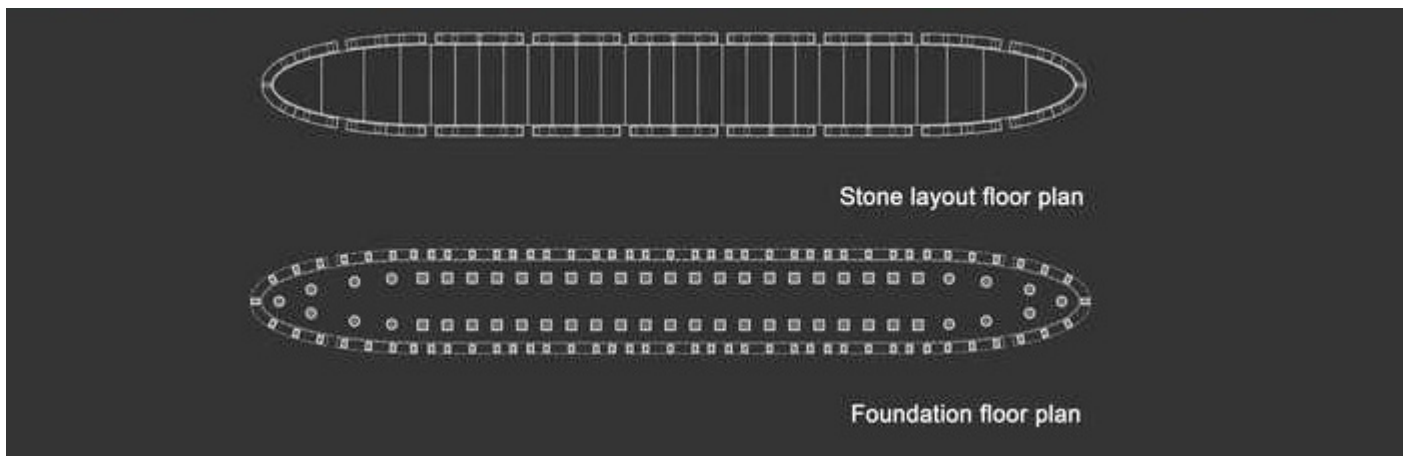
Planta de despiece de la mesa parroquial. Las dimensiones de esta son 33 m de largo y 3,5 metros de ancho, elevada sobre pequeños pilares de granito. El banco perimetral posee pequeñas aperturas.
